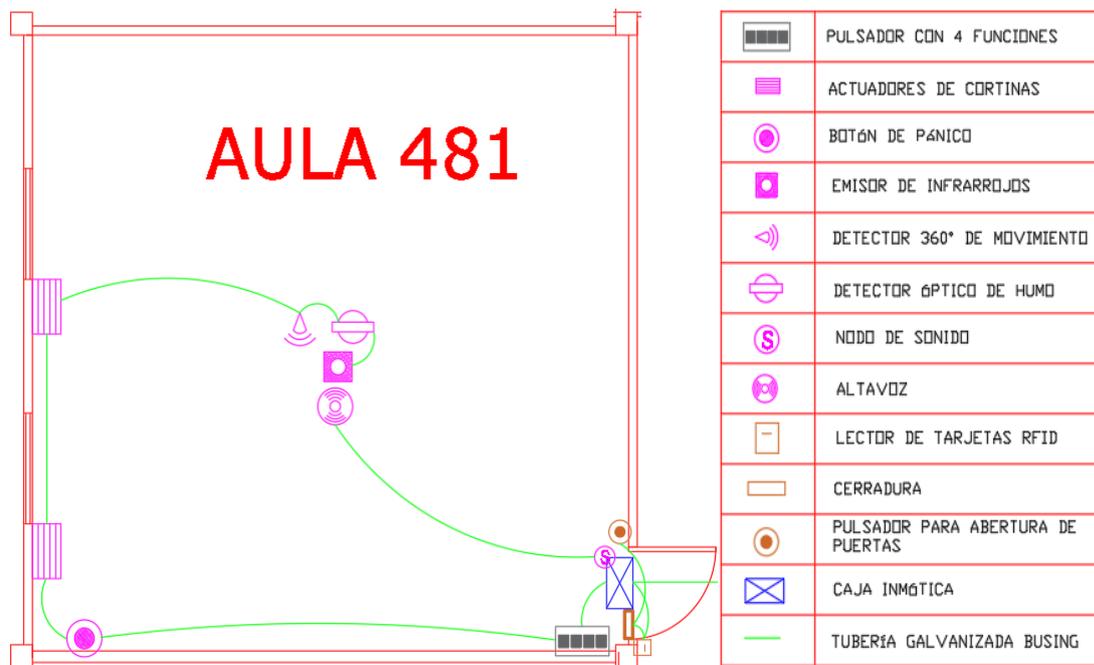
Ubicación y nomenclatura de dispositivos en Aulas Planta Alta
